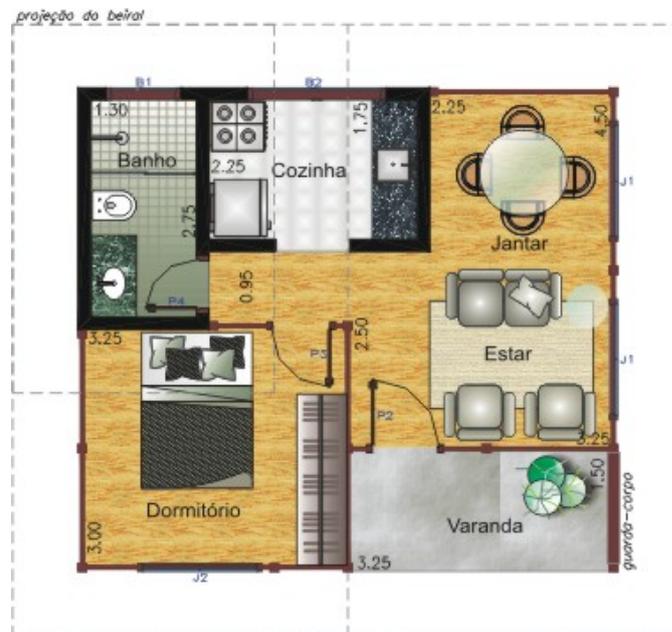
Planta de arquitetura de moradia em madeira (obtida no site, [Madeira, 2013](#))
